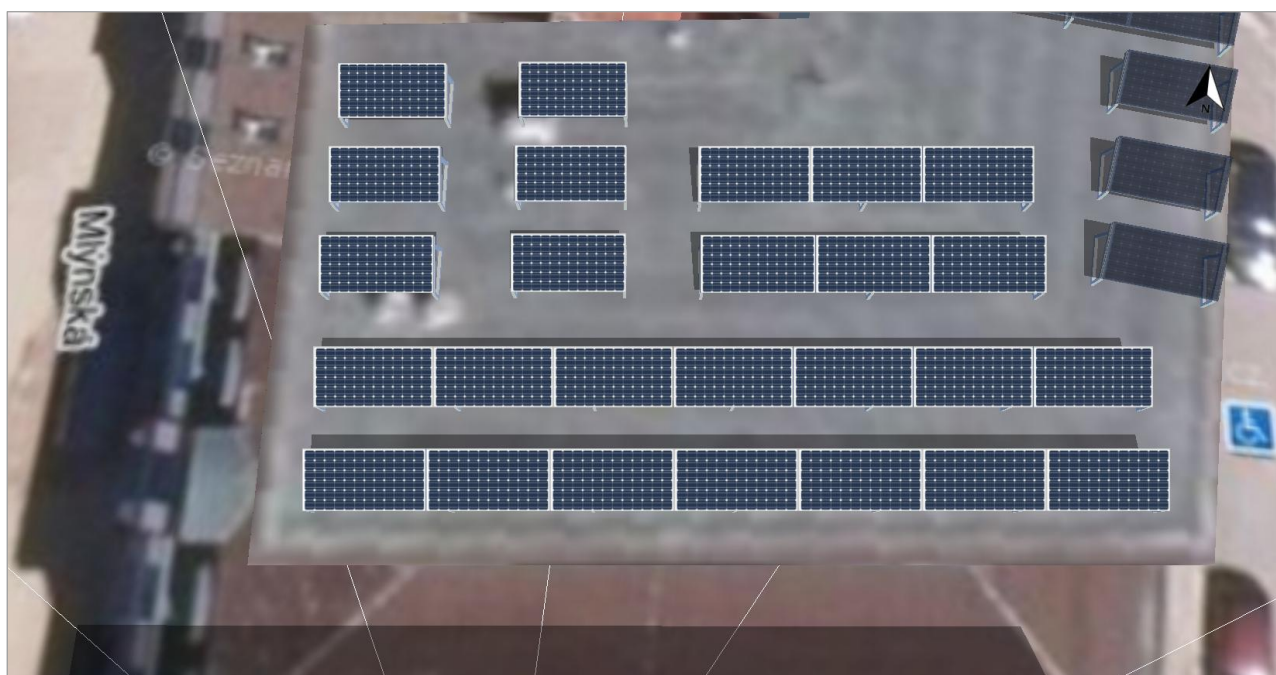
Plocha modulu - Arbitrary Building 01-Mounting Surface West
